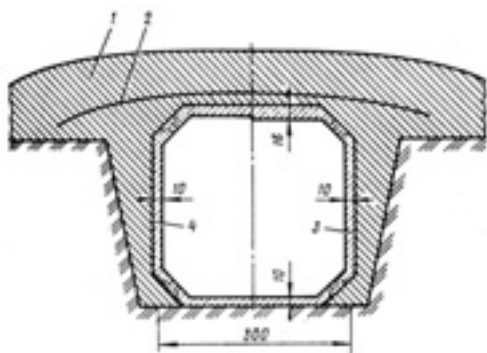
Быстровозводимое убежище из элементов стен силосов: 1 – насыпной грунт; 2 – гидроизоляция; 3 – блок CO_1-1 ; 4 – блок $CO-1$
